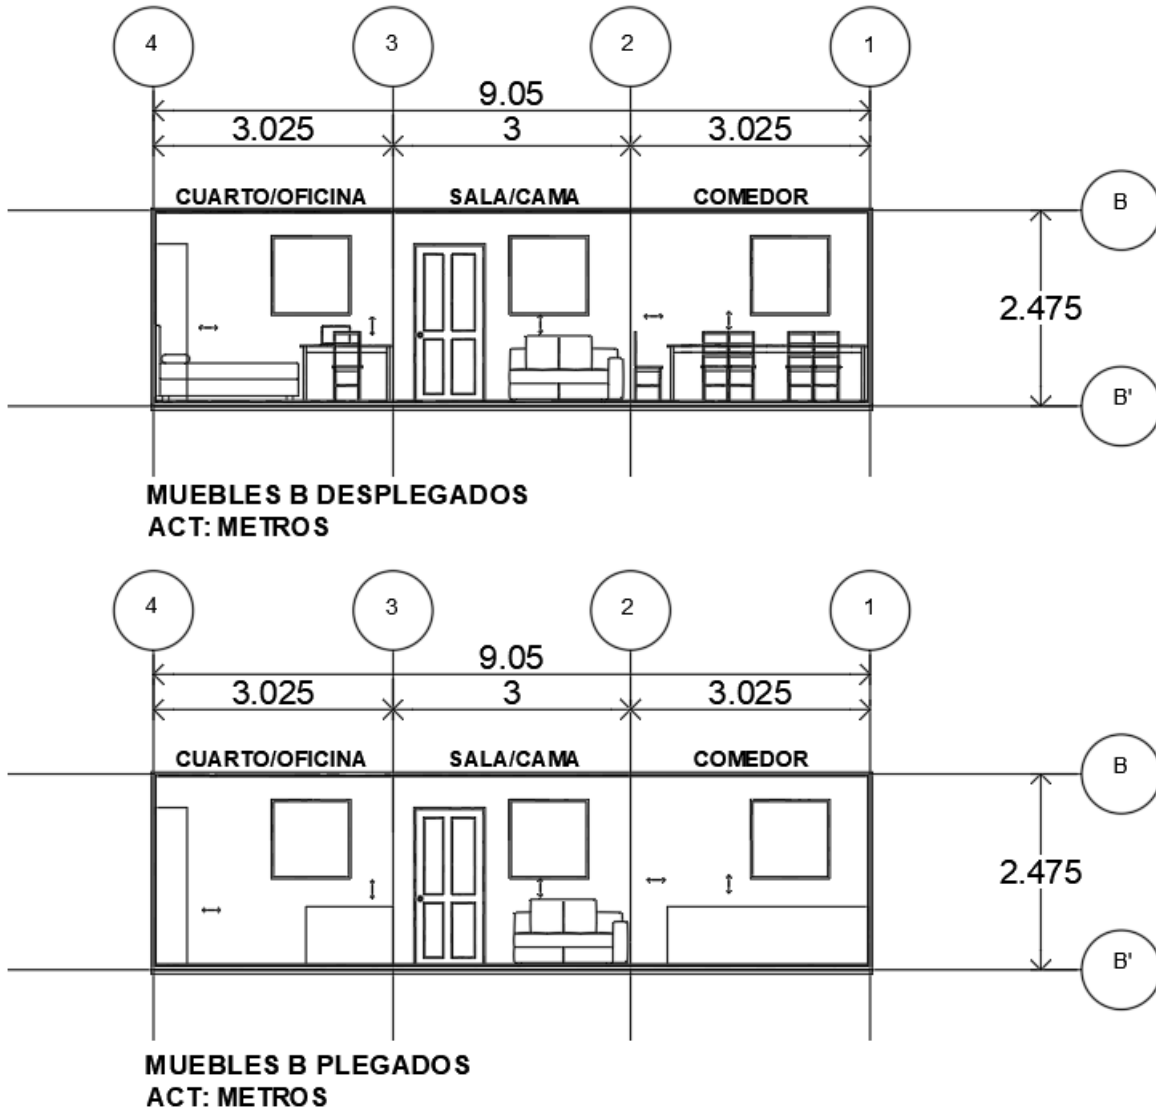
Alzado B muebles (Elaboración propia, 2023)
